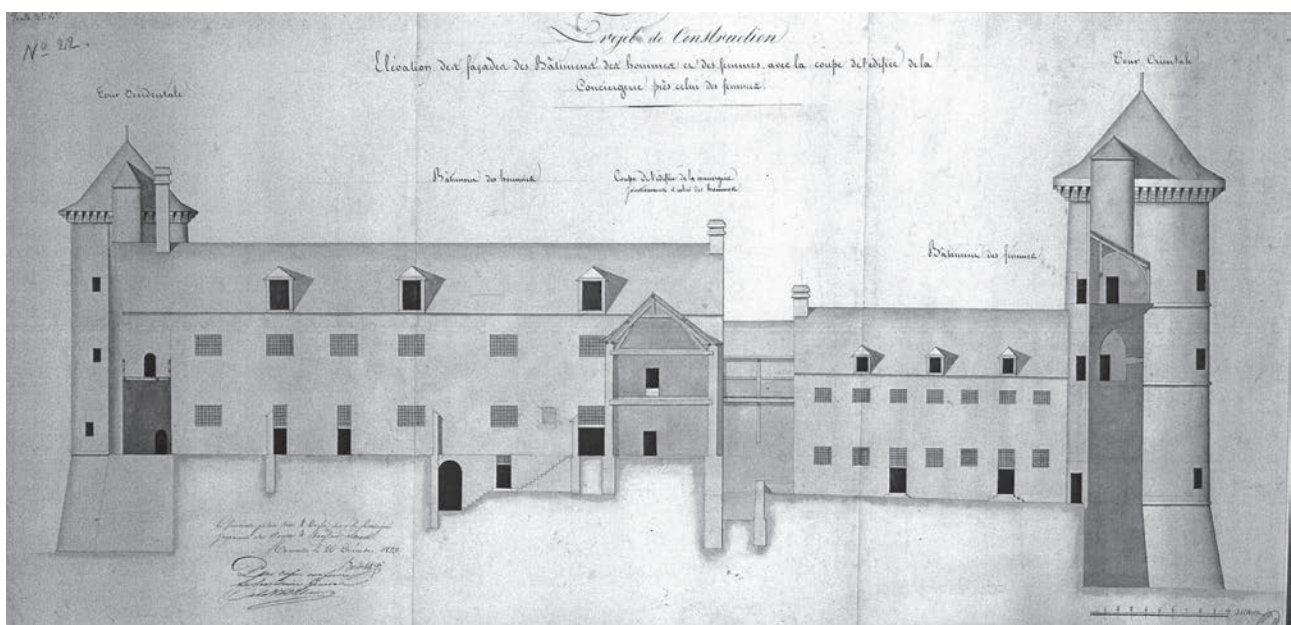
vue du plan de la maison d'arrêt départementale, dressé par Burdelot en 1823 (musée du château de Vitré)
